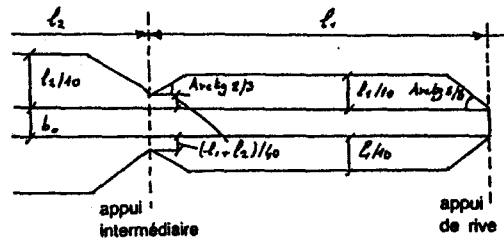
b. Largeur de calcul d'une poutre en T
